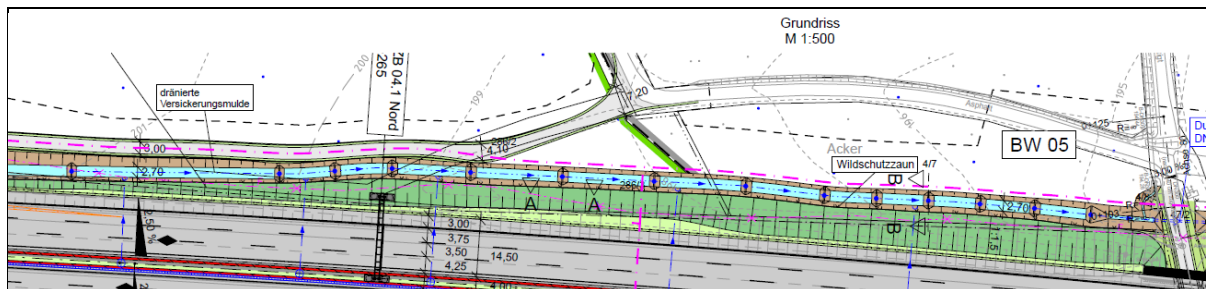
Grundriss der drainierten Versickerungsmulde (Behandlungsanlage 02.1)
